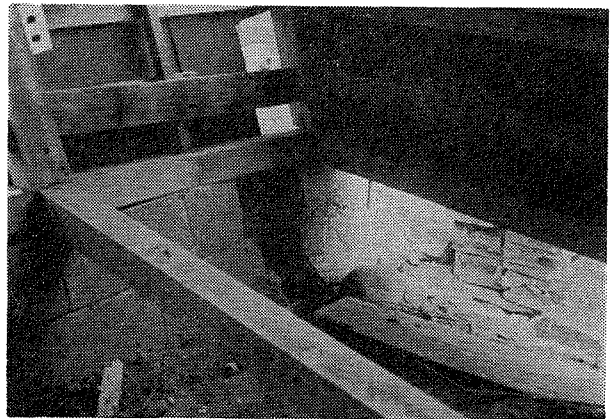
コンクリート・ブロック基礎の破壊（入間地区）
